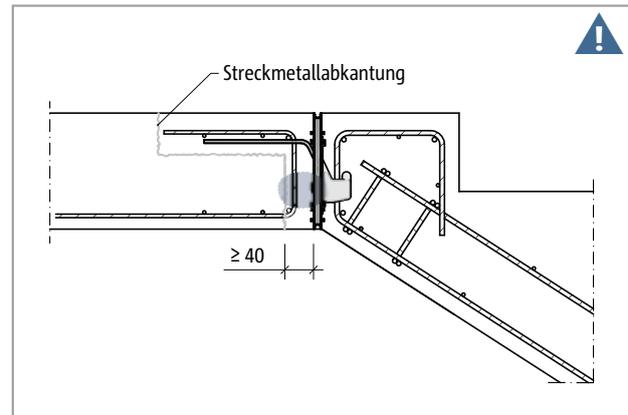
Schöck Tronsole® Typ T: Einbau in Verbindung mit Arbeitsfugen am Deckenrand, Druckfuge deckenseitig
